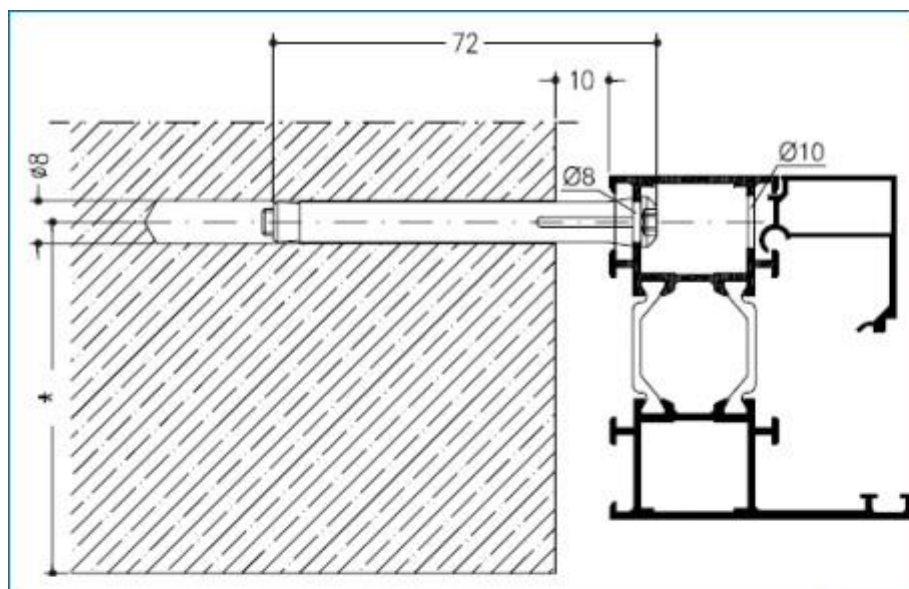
Upevnenie pomocou dlhých skrutiek
